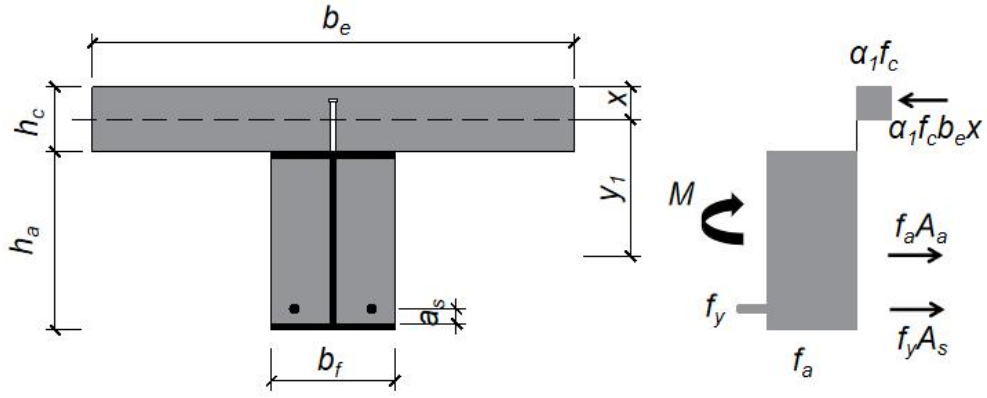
中和轴位于混凝土板中时的组合截面及应力图形
